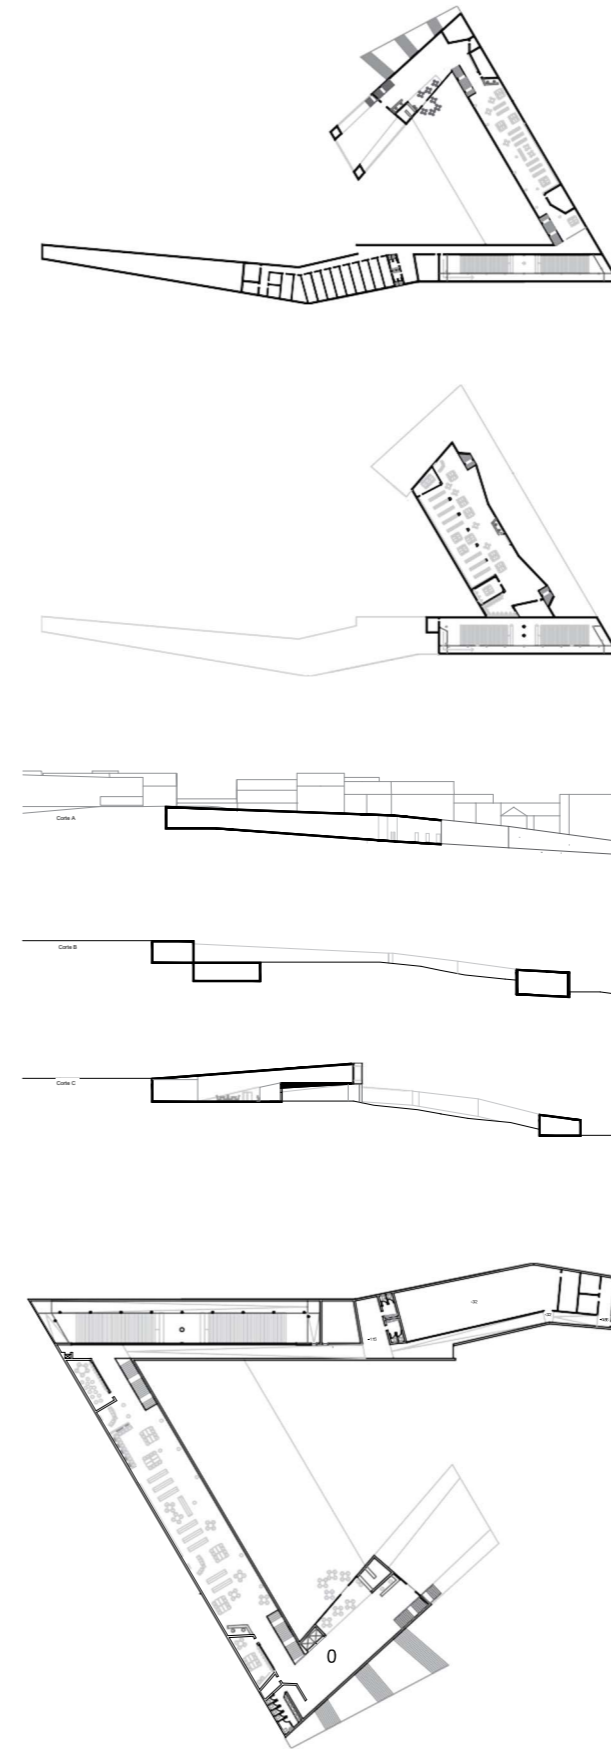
Desenhos de estudo do autor, Planta piso 0, -1, Cortes transversais, Planta piso 0
